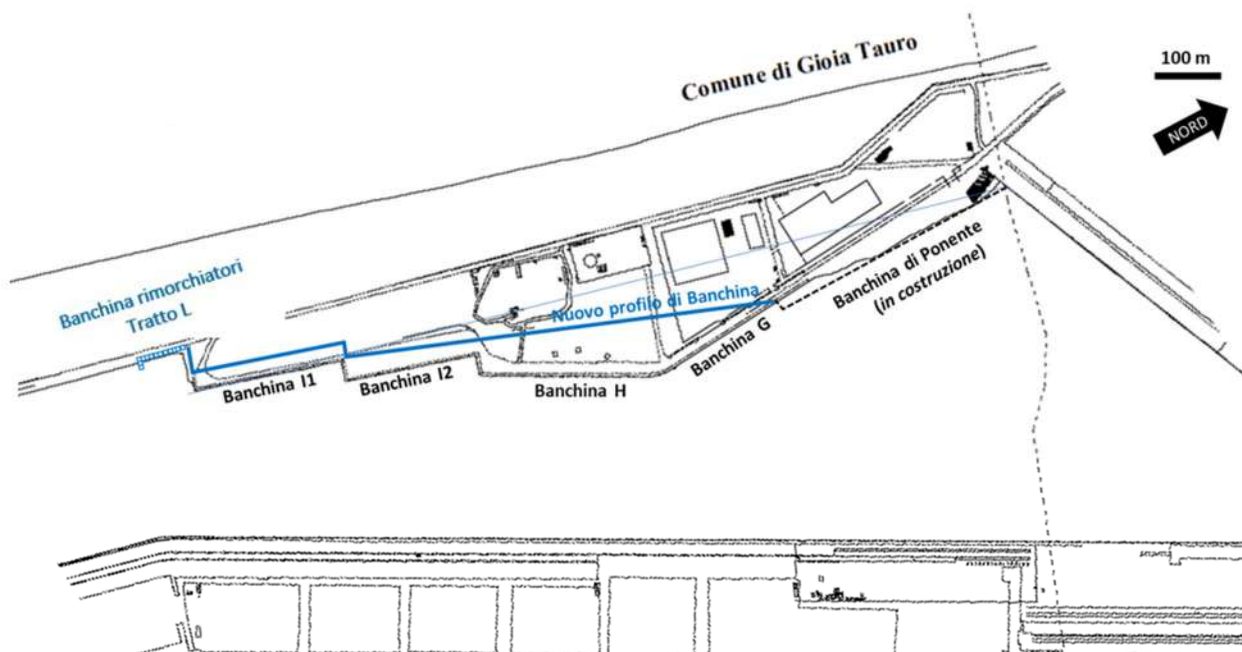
Planimetria del porto di Gioia Tauro con l'indicazione dei banchinamenti interessati dagli interventi
